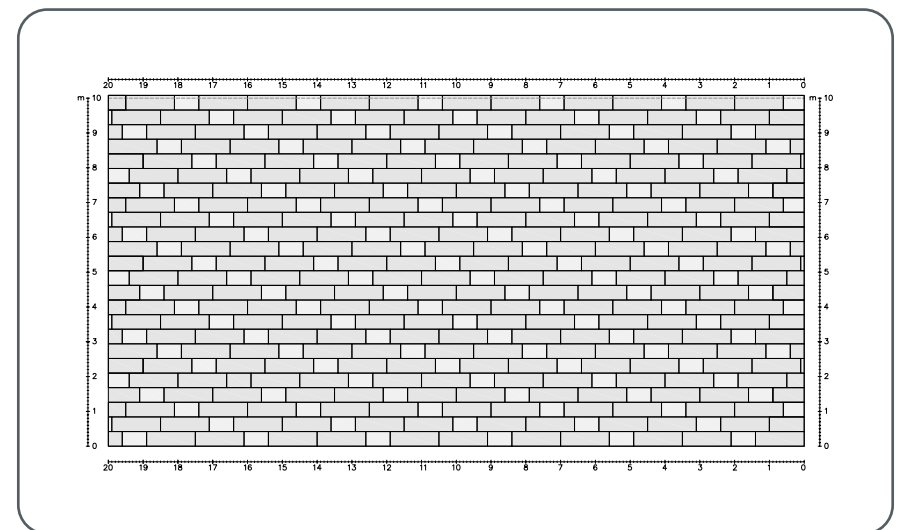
Panneau de façade FX.12 – exemple de pose 2
